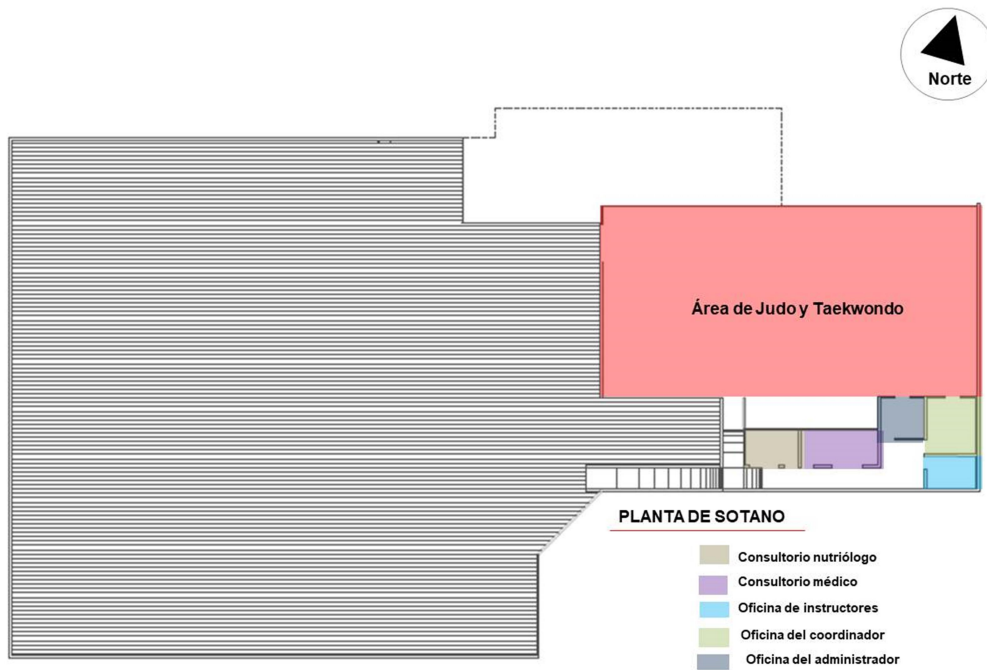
Zonificación planta de sótano. Imagen 89: Zonificación planta baja.
